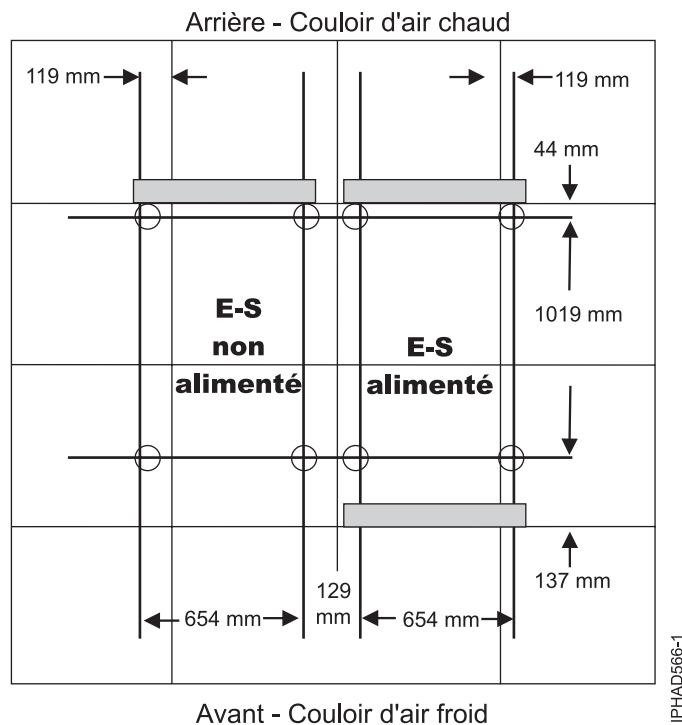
Positionnement de l'armoire pour dalles de 600 mm
